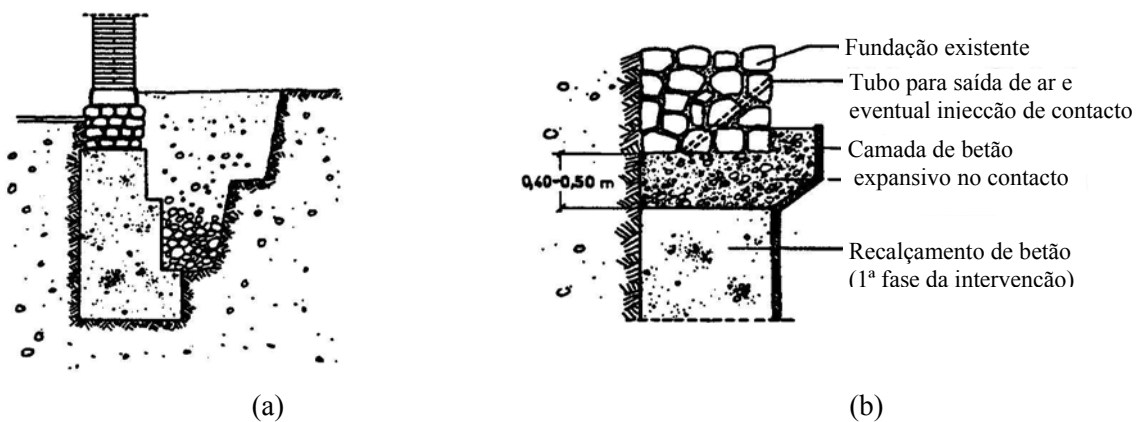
Rebaixamento da cota de fundação [Rodríguez Ortiz, 2002]: (a) recalçamento da fundação existente com betão, ciclópico ou armado; (b) pormenor do interface de ligação entre o recalce e a fundação existente, com utilização de betão expansivo.
